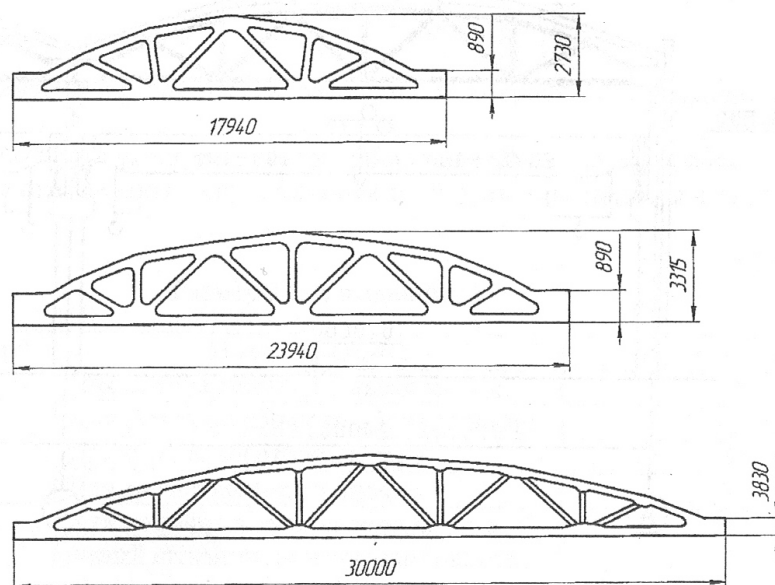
габаритные размеры железобетонных ферм покрытий (стропильных ферм)
